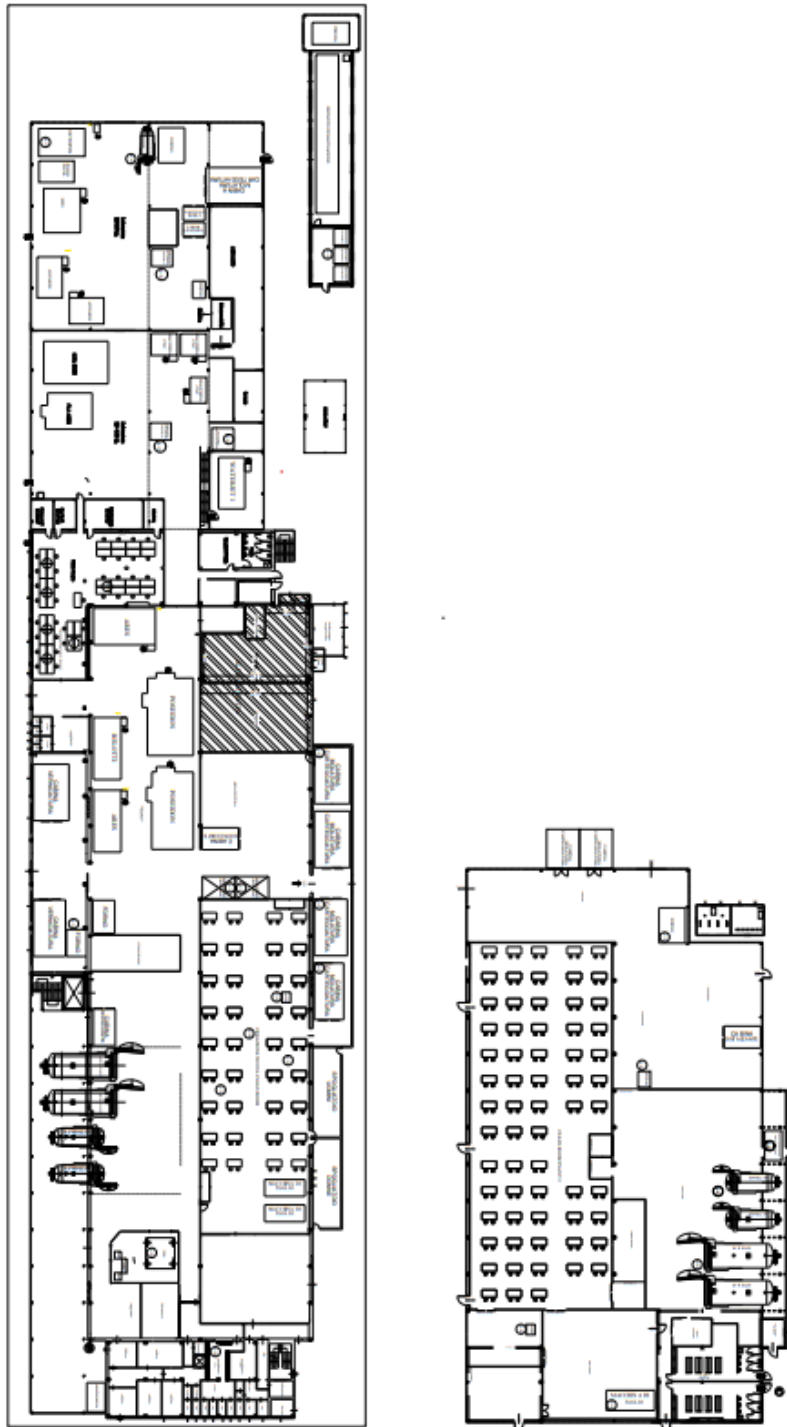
stabilimento ArsTech a Colonnella, plant 1)
